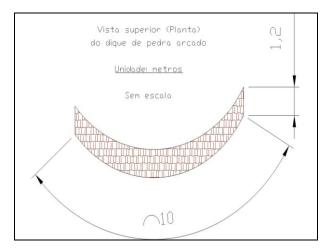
a - Dimensão de um dique de pedra rachão – vista superior (em planta).
